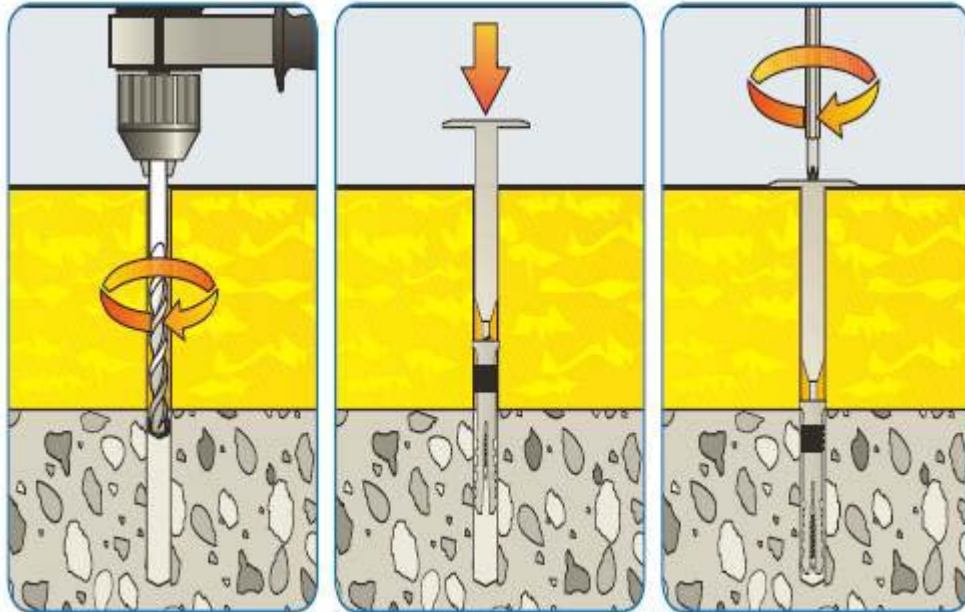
Механическое крепление гидро-теплоизоляции к железобетонному основанию
